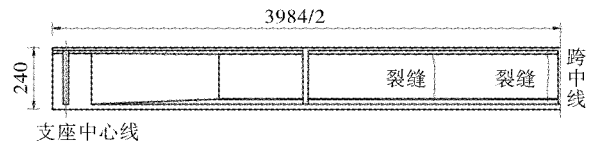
边跨中梁(编号 3-2 T 梁)立面及裂缝位置示意
